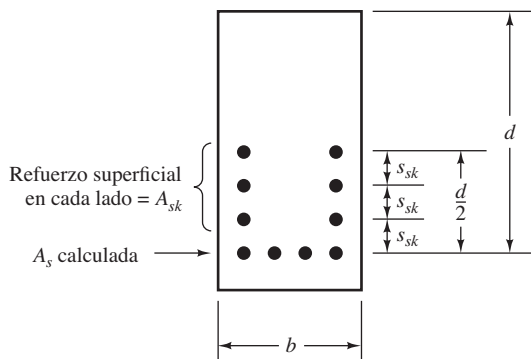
Refuerzo superficial para vigas profundas con $h > 36$ plg, según se requiera por la sección 9.7.2.3 del código ACI.
